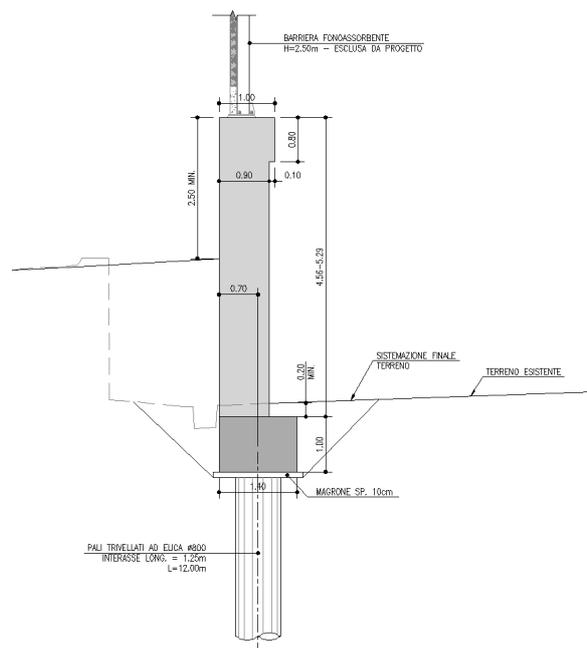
Sezione tipo opera di sostegno MS026 (tratto 1)
